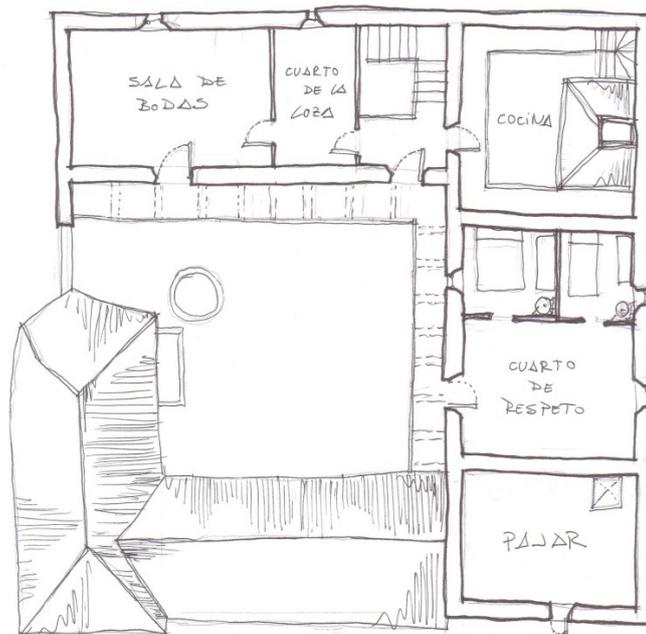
Planta alta de una casa arriera. Cedido por Javier Sastre.
